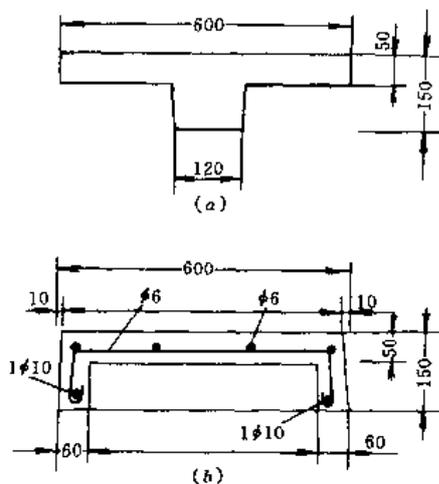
槽形板折算型式与配筋图(单位:mm)
